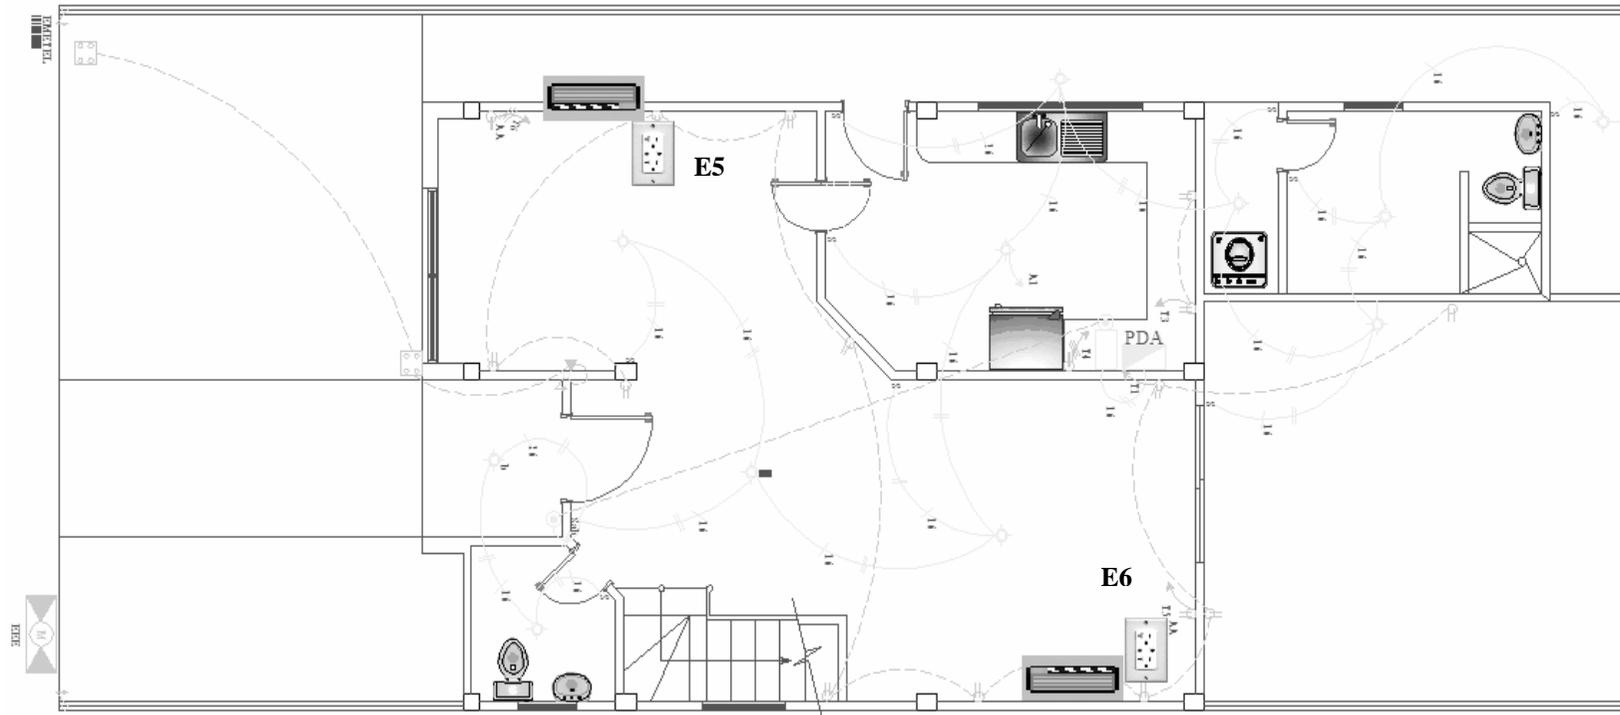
Sistema de Climatización, Planta Baja, Plano Eléctrico.
